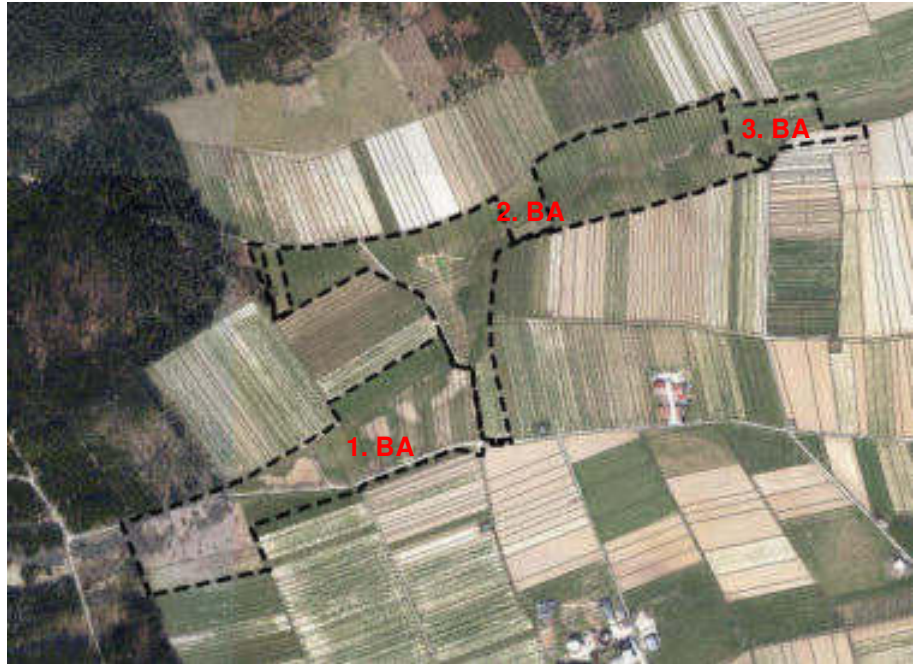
Detaillage mit Markierung der Bauabschnitte (BA)
